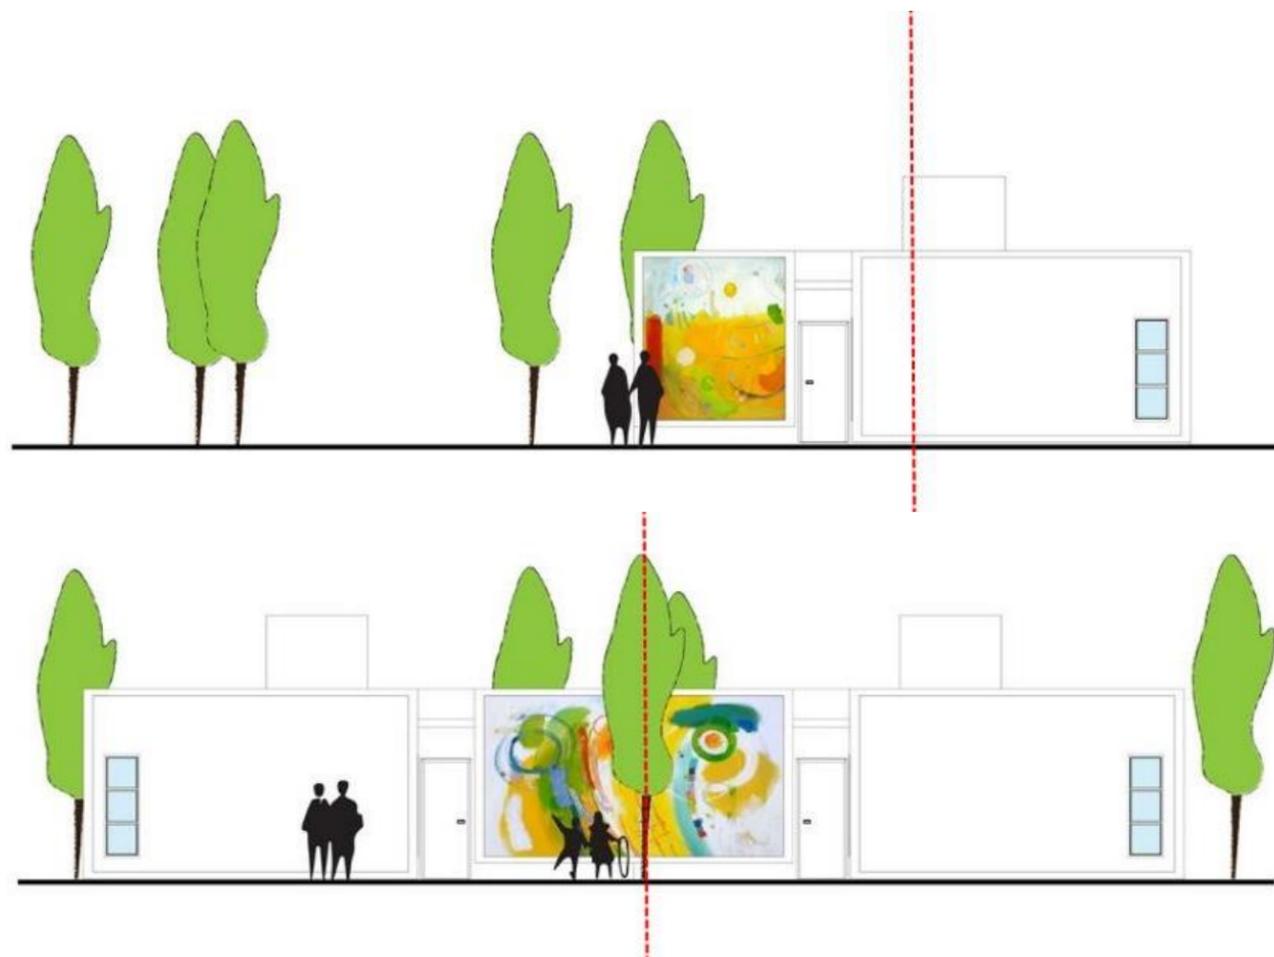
Elevaciones arquitectónica "Casa dos Caseiros"
